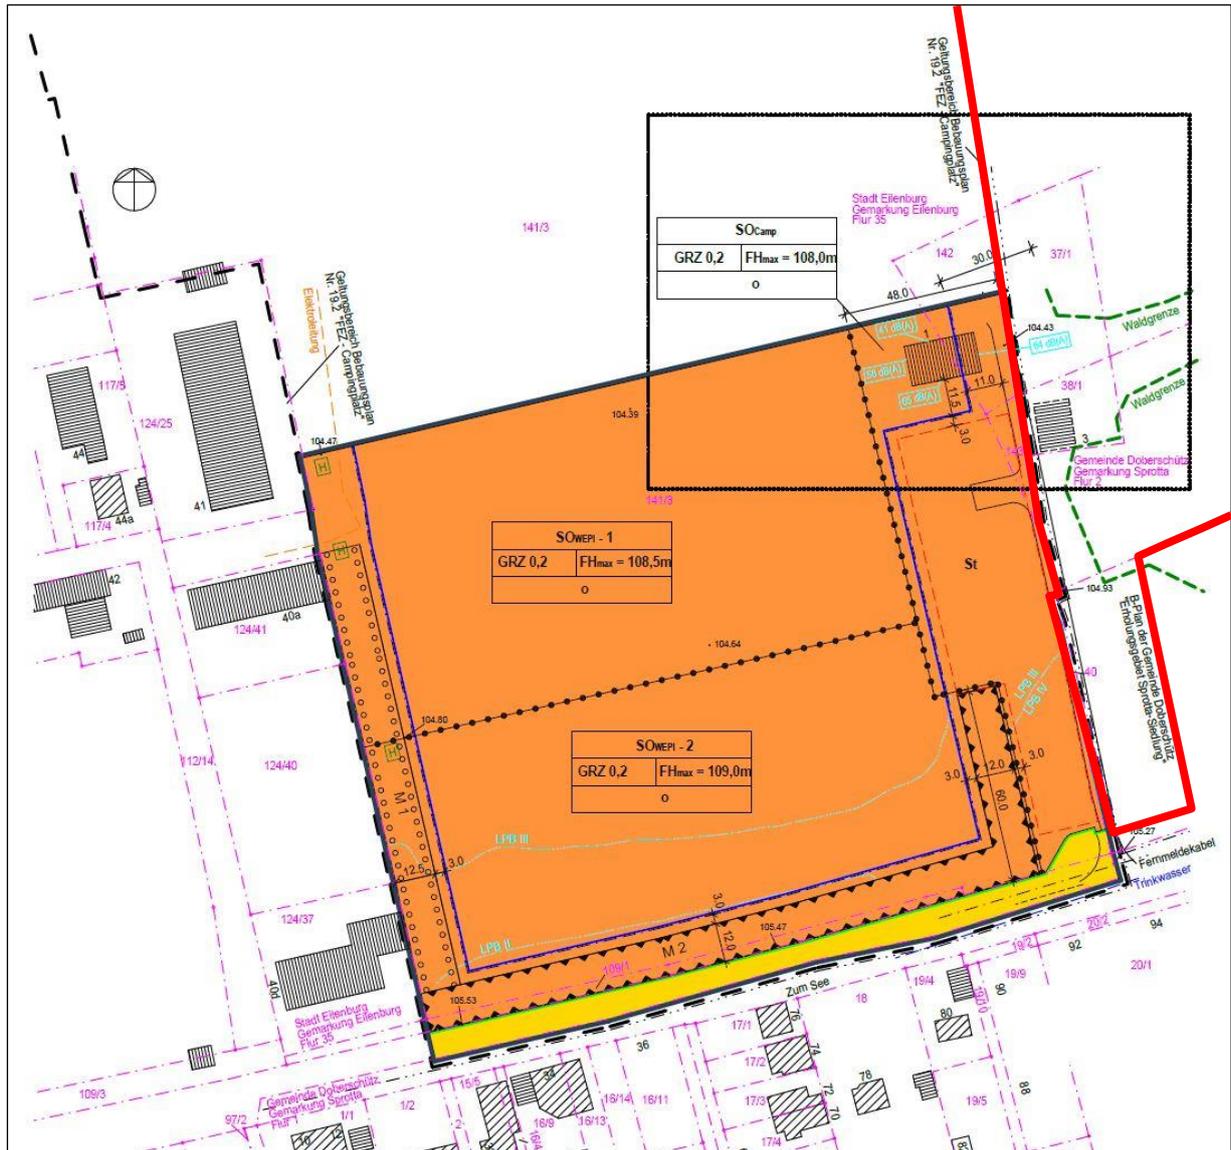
Benachbarter Bebauungsplan Nr. 19.3 „FEZ - Wochenendplatz“ der Stadt Eilenburg nicht maßstäblich)
